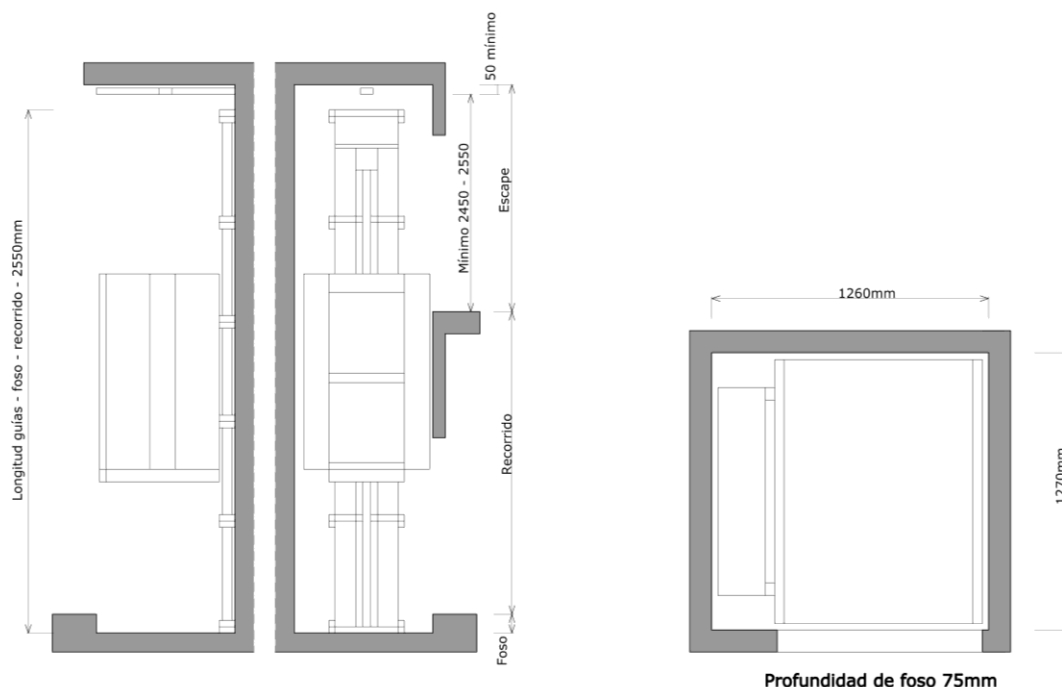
Plano de sección del elevador vertical. Plano de planta del elevador vertical.
